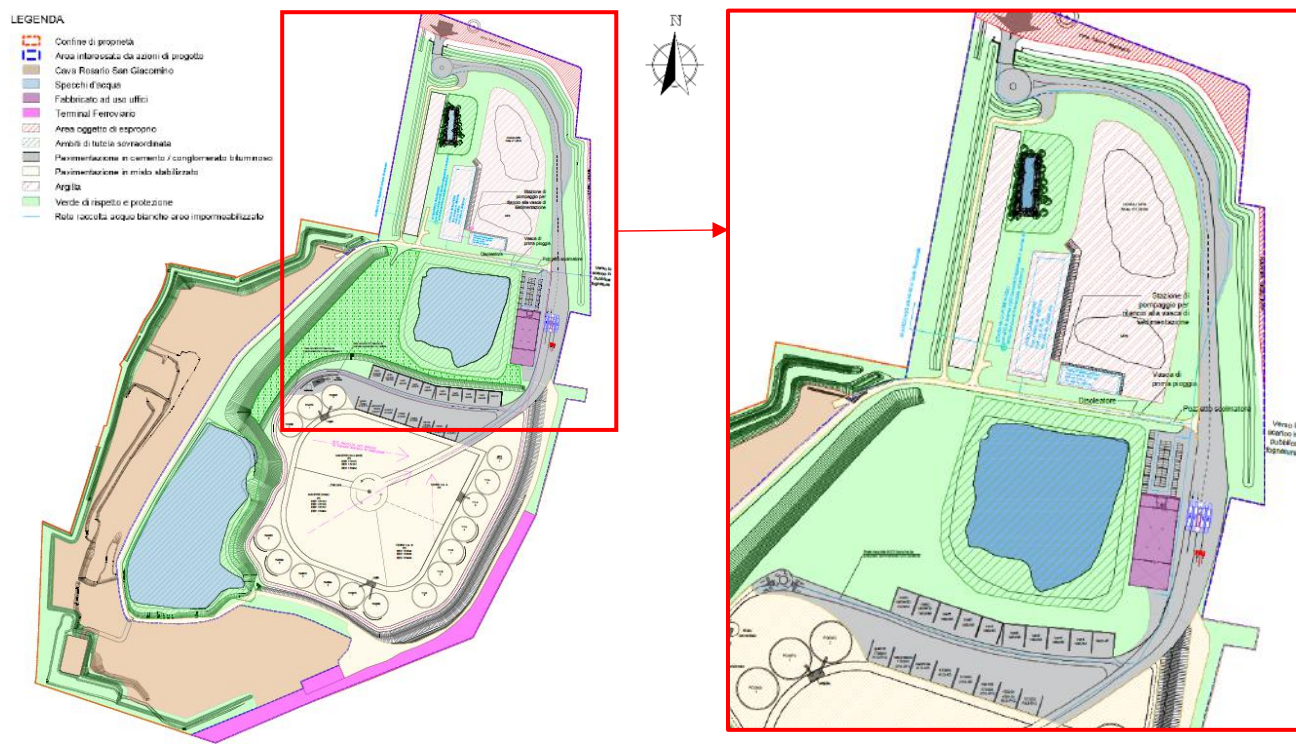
Ipotesi rete fognaria aree impermeabilizzate (linea azzurra)
